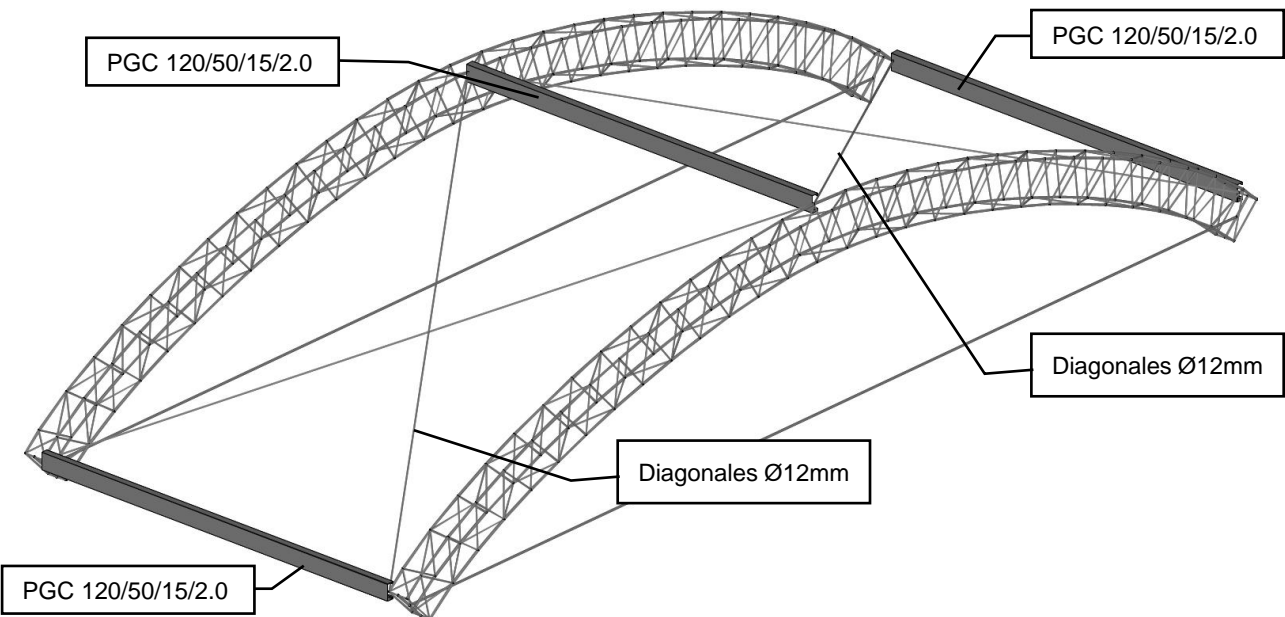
ARRIOSTRAMIENTO TRANSVERSAL | ESQUEMA 3D
